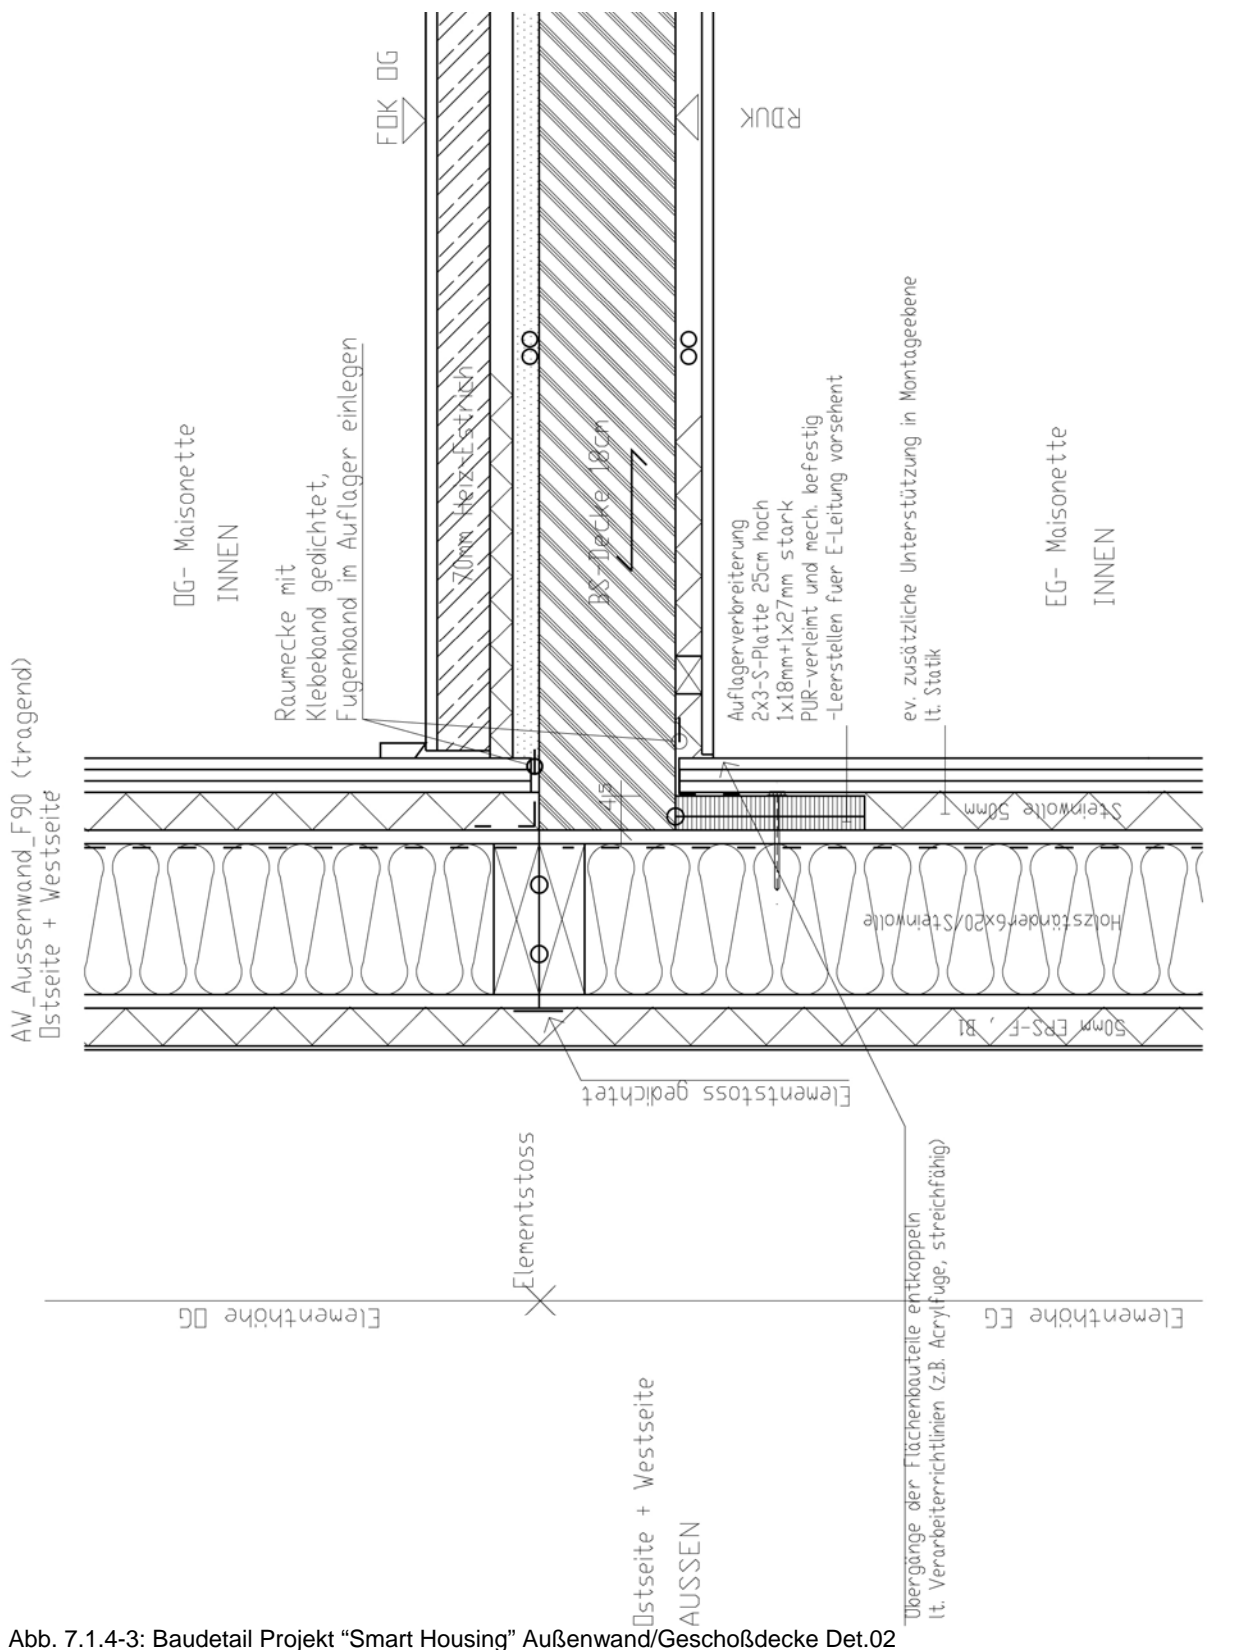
Baudetail Projekt "Smart Housing" Außenwand/Geschoßdecke Det.02
